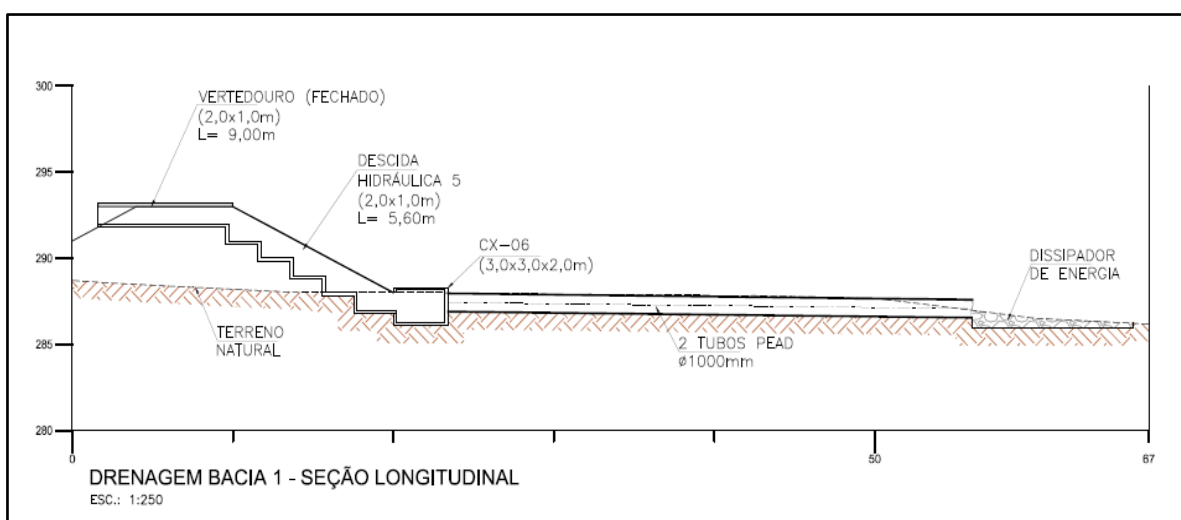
Bacia 1– Detalhe da estrutura de drenagem da bacia 1
